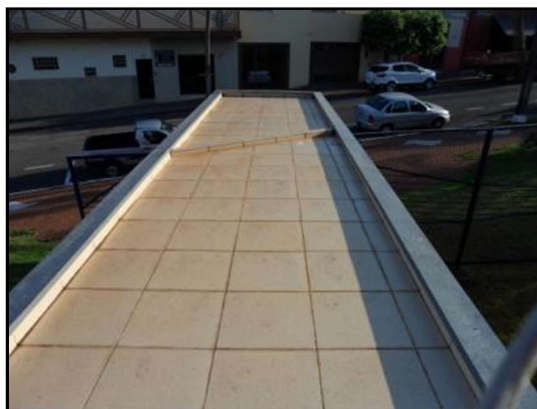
Foto ilustrativa do local onde será instalada a barreira de alvenaria sobre laje do túnel
